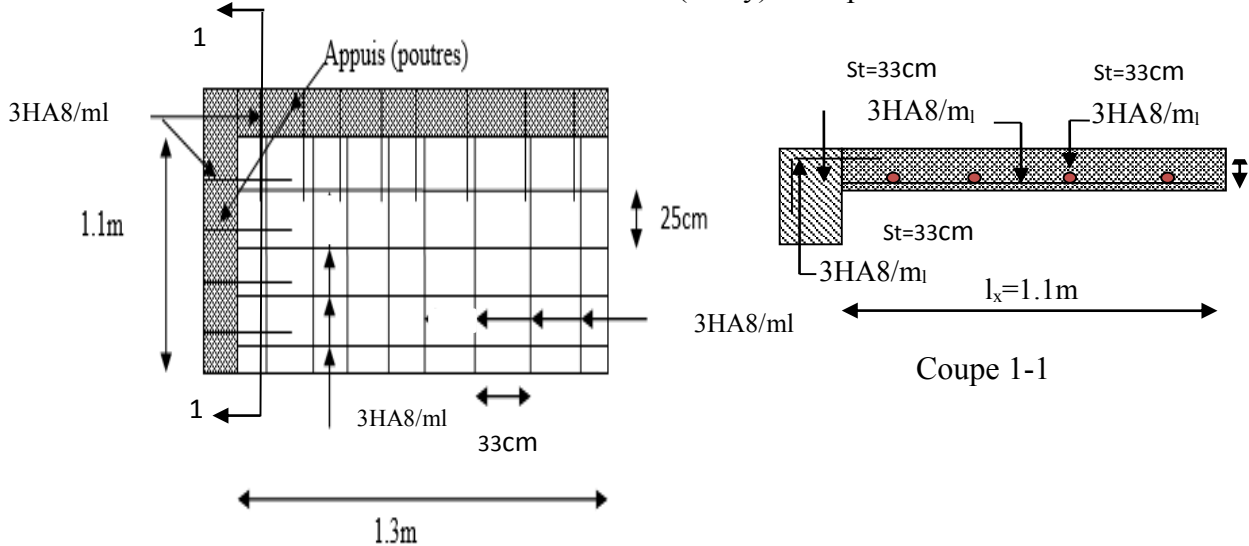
schéma de ferrailage des dalles sur 2 appuis.
